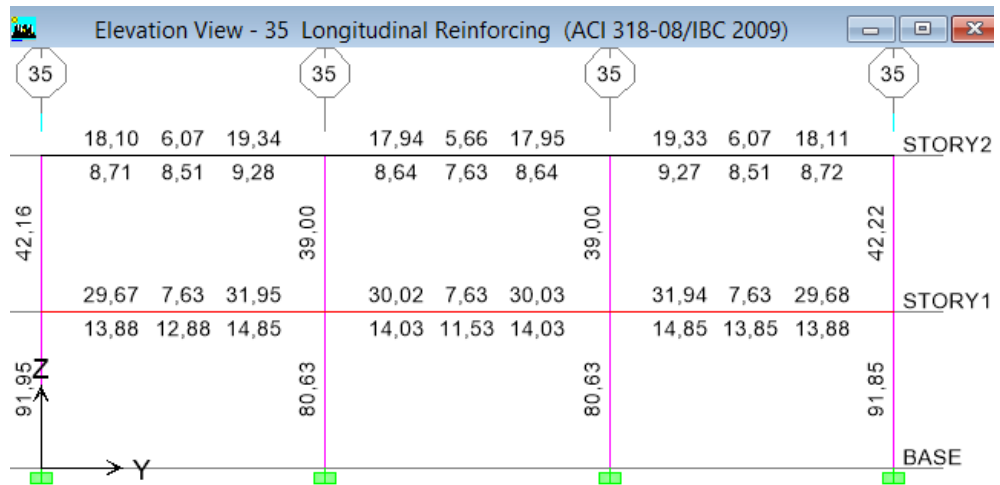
Acero en Vigas y Columnas en el Pórtico 35 – Obstetricia - (NEC-11)
